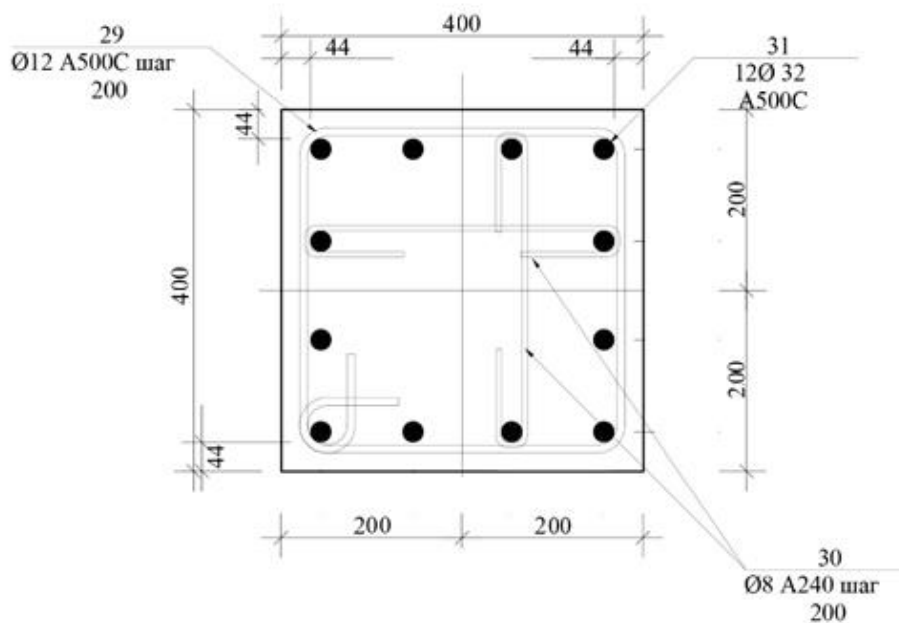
Армирование колонны в поперечном разрезе
